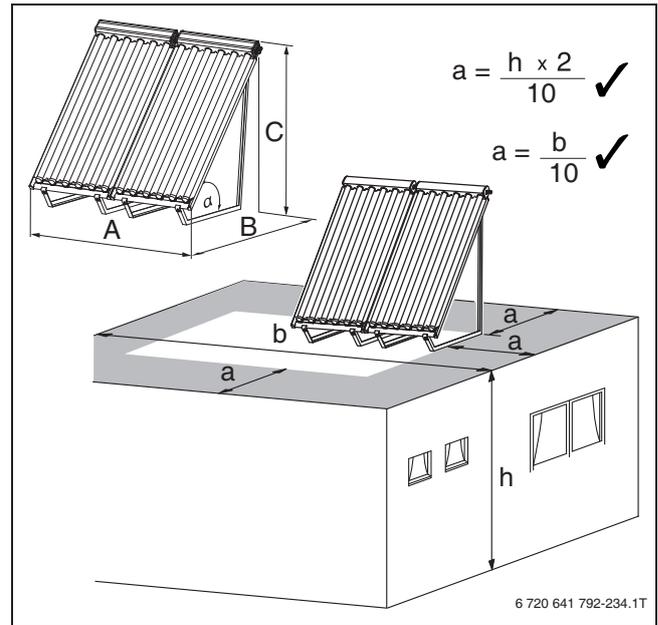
Distanza minima dal perimetro del tetto (misura a); applicare una formula (possibili entrambe)
